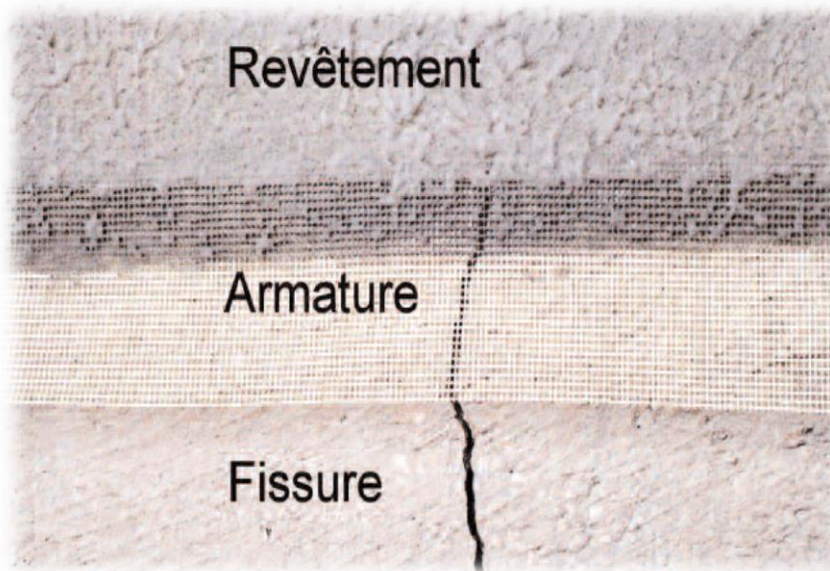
Pontage d'une fissure avec incorporation d'une armature
